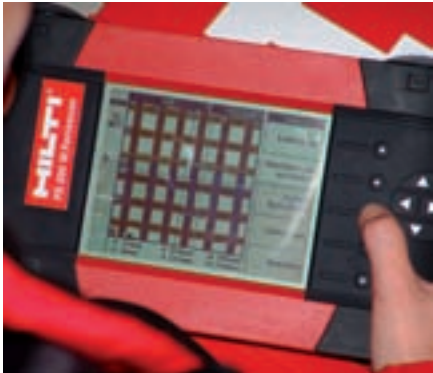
Bewehrungssuche mit Ferrosan PS 200
